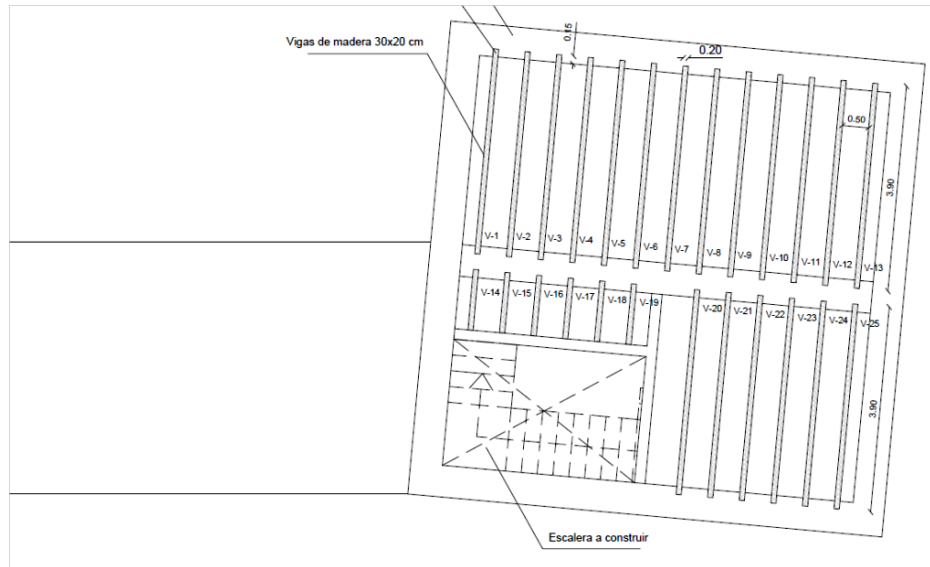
Sistema estructural del forjado de planta primera del molino. (Fuente propia)
